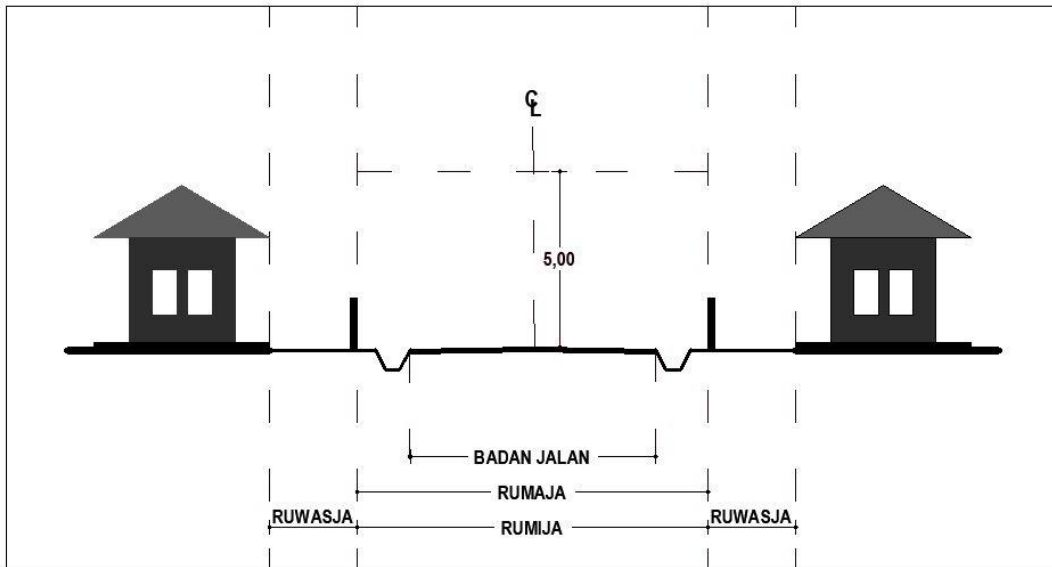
Penempatan Bangunan dan Jaringan Utilitas di Bawah Tanah di Ruang Milik Jalan Tipe 3
